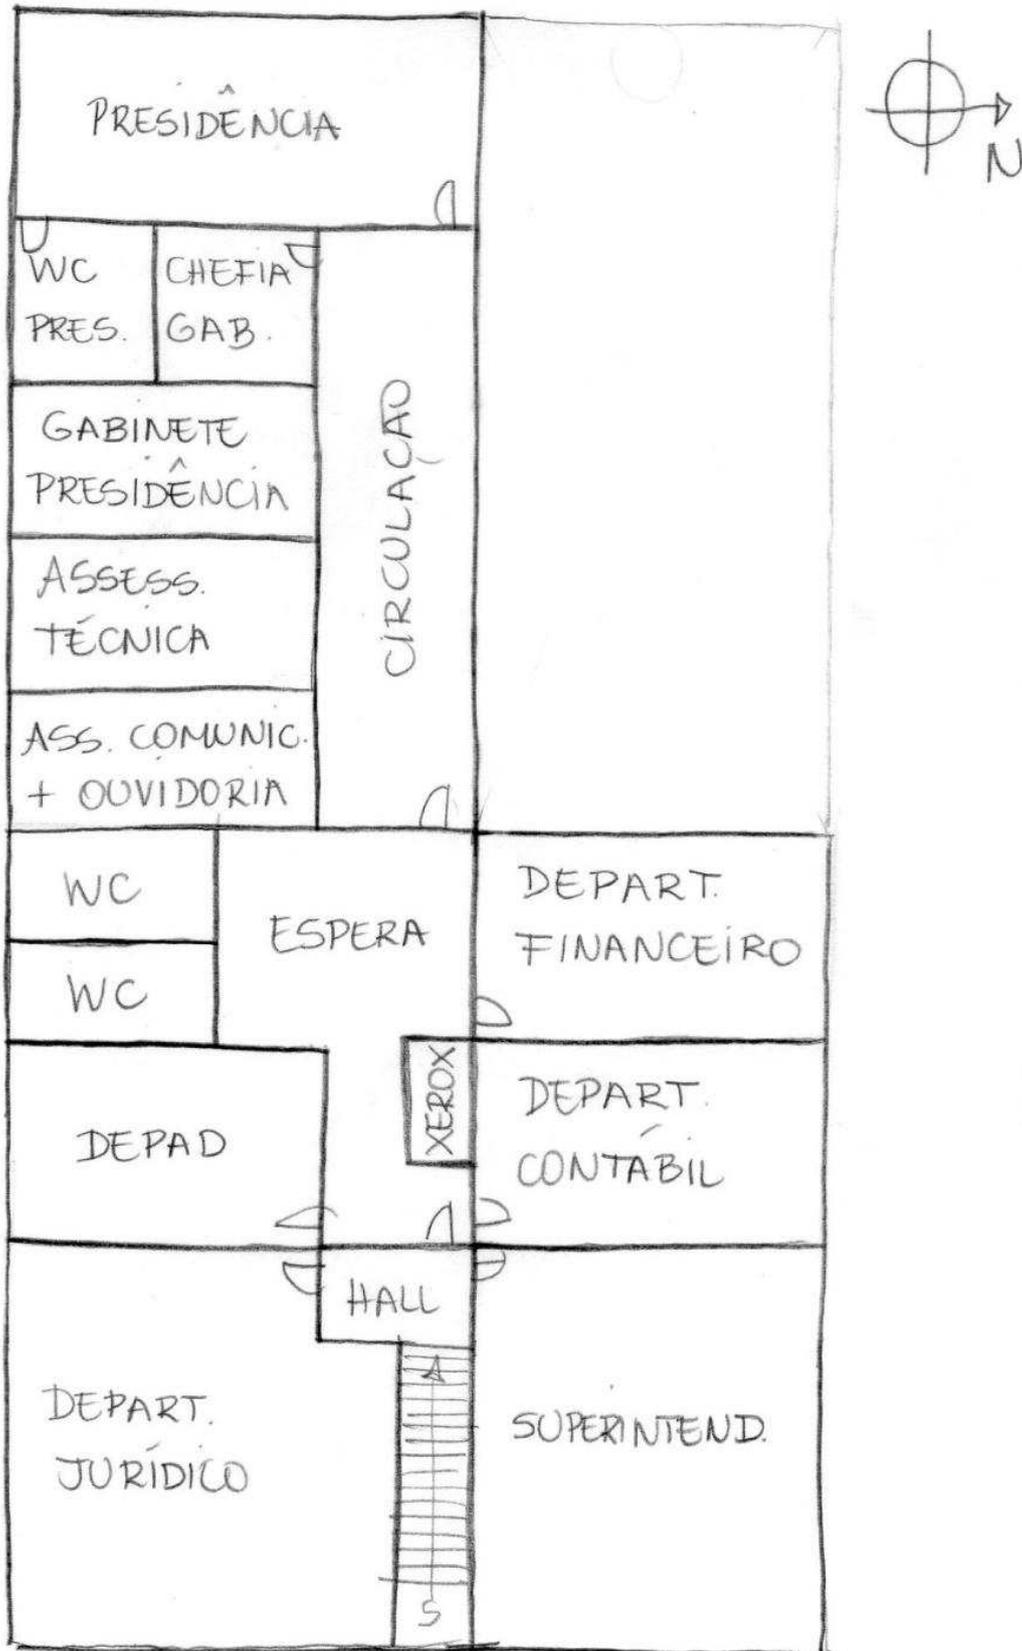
Croqui Planta Baixa 1º Pavimento CREA/MA
